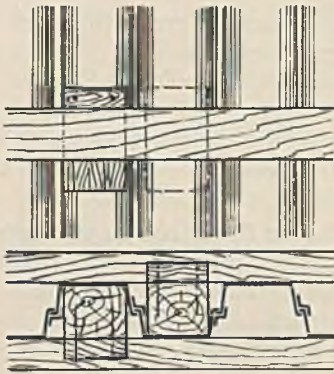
Anlegen der Führungszangen beim Rammen eiserner Spundwände.
